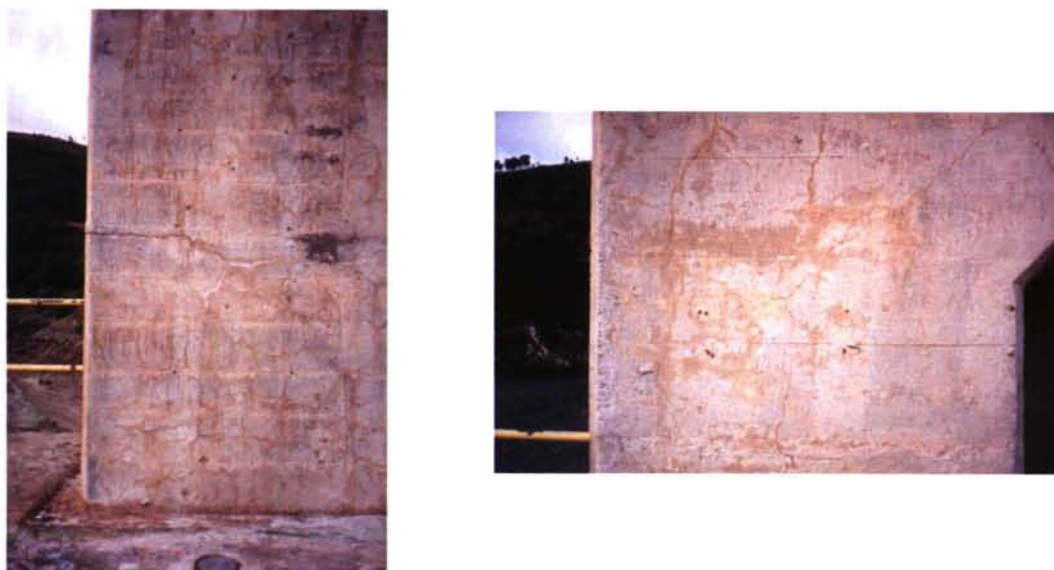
Fisuración en mapa en el pórtico superior de la presa
